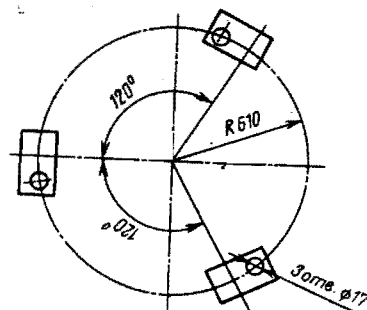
План расположения отверстий под фундаментные болты резервуара универсального марки Г2-ОТ2-А
